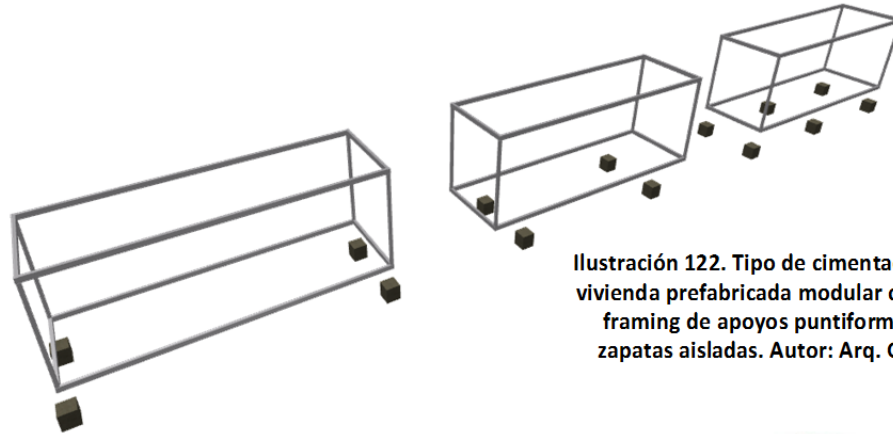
Tipo de cimentación elegida para la vivienda prefabricada modular con el sistema steel framing de apoyos puntiformes a base pilas o zapatas aisladas. Autor: Arq. Giovanni Jiménez
